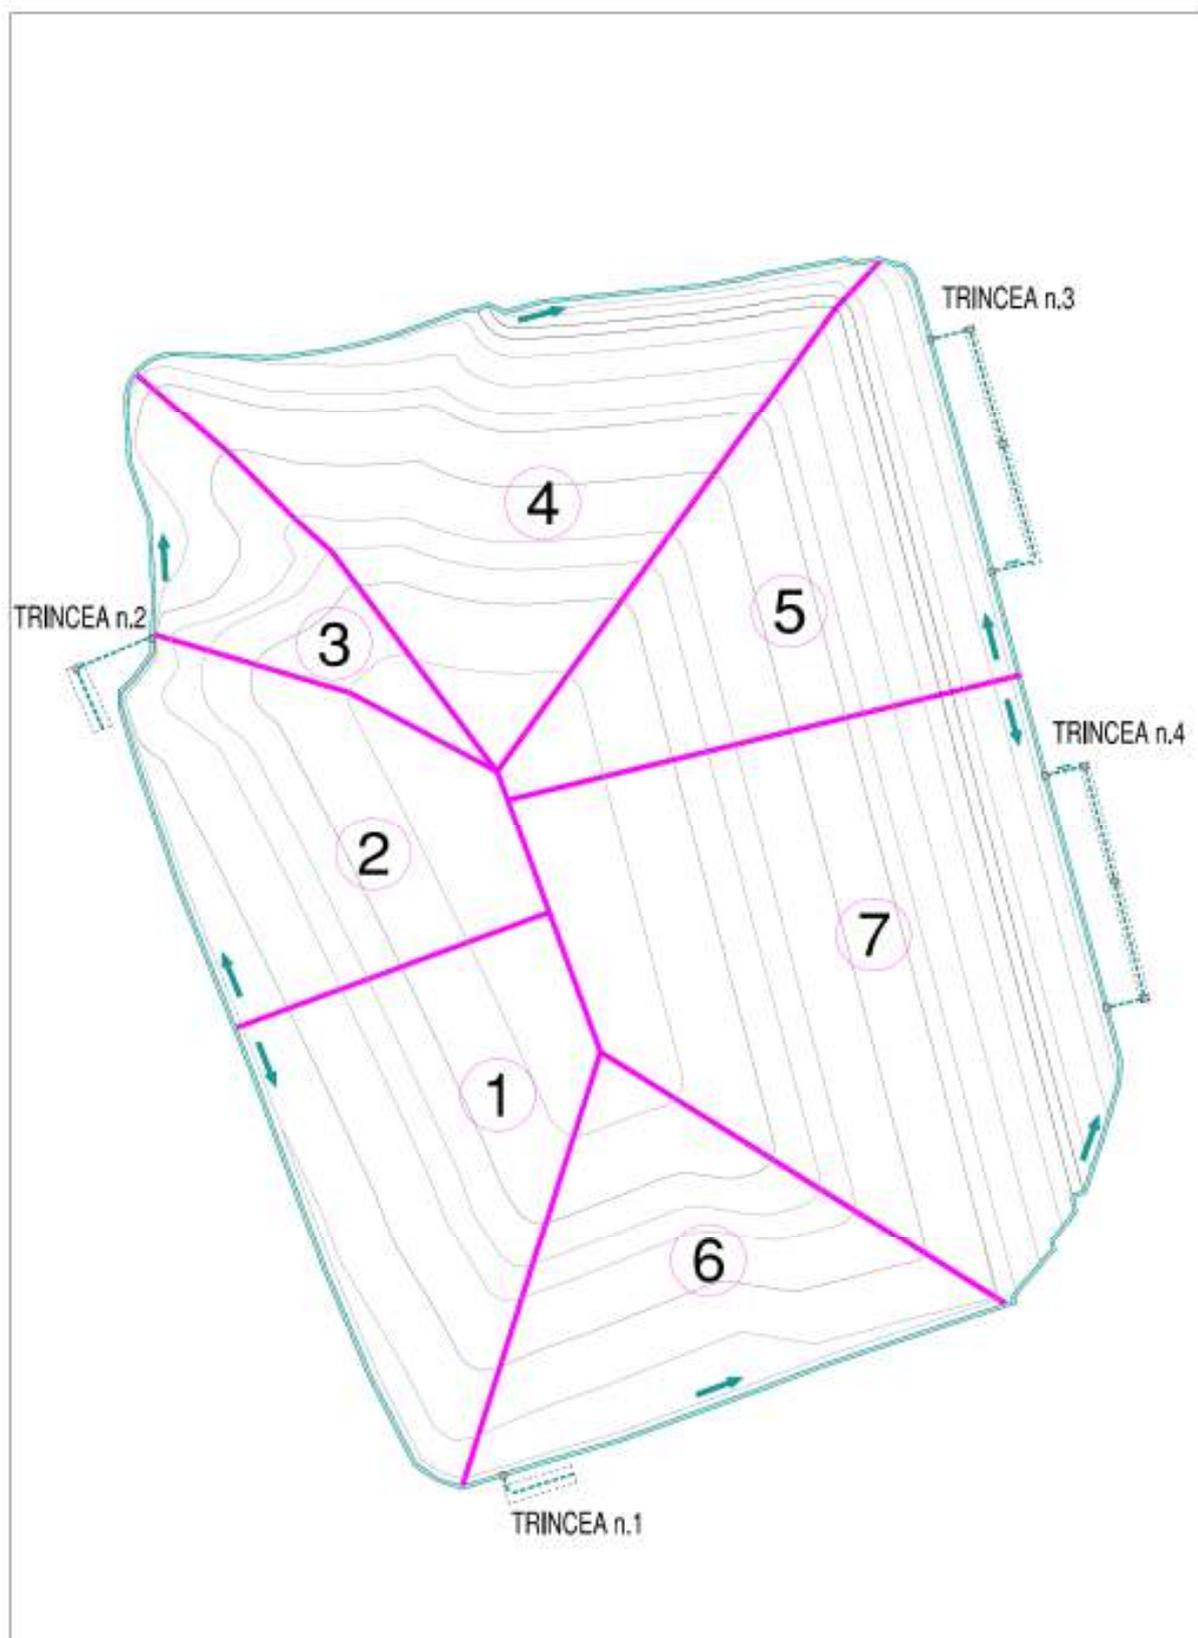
Schema planimetrico della discarica con suddivisione delle aree
